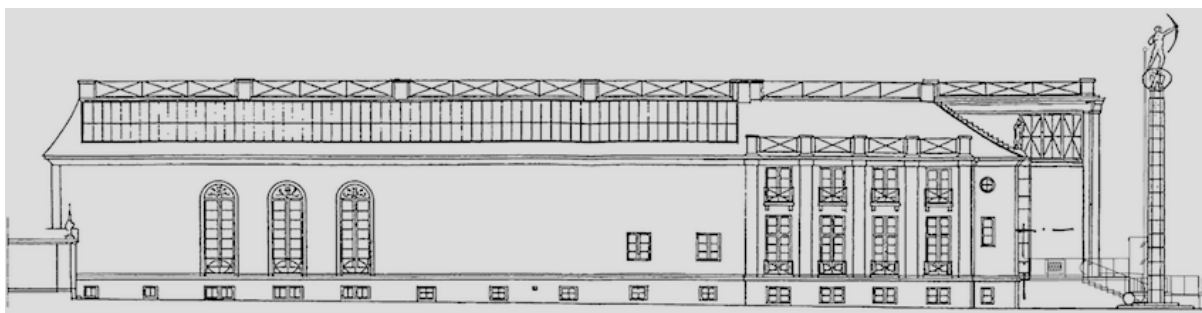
Ritning östra fasaden. (Bygg- och plantjänsten, Stockholms stad)
